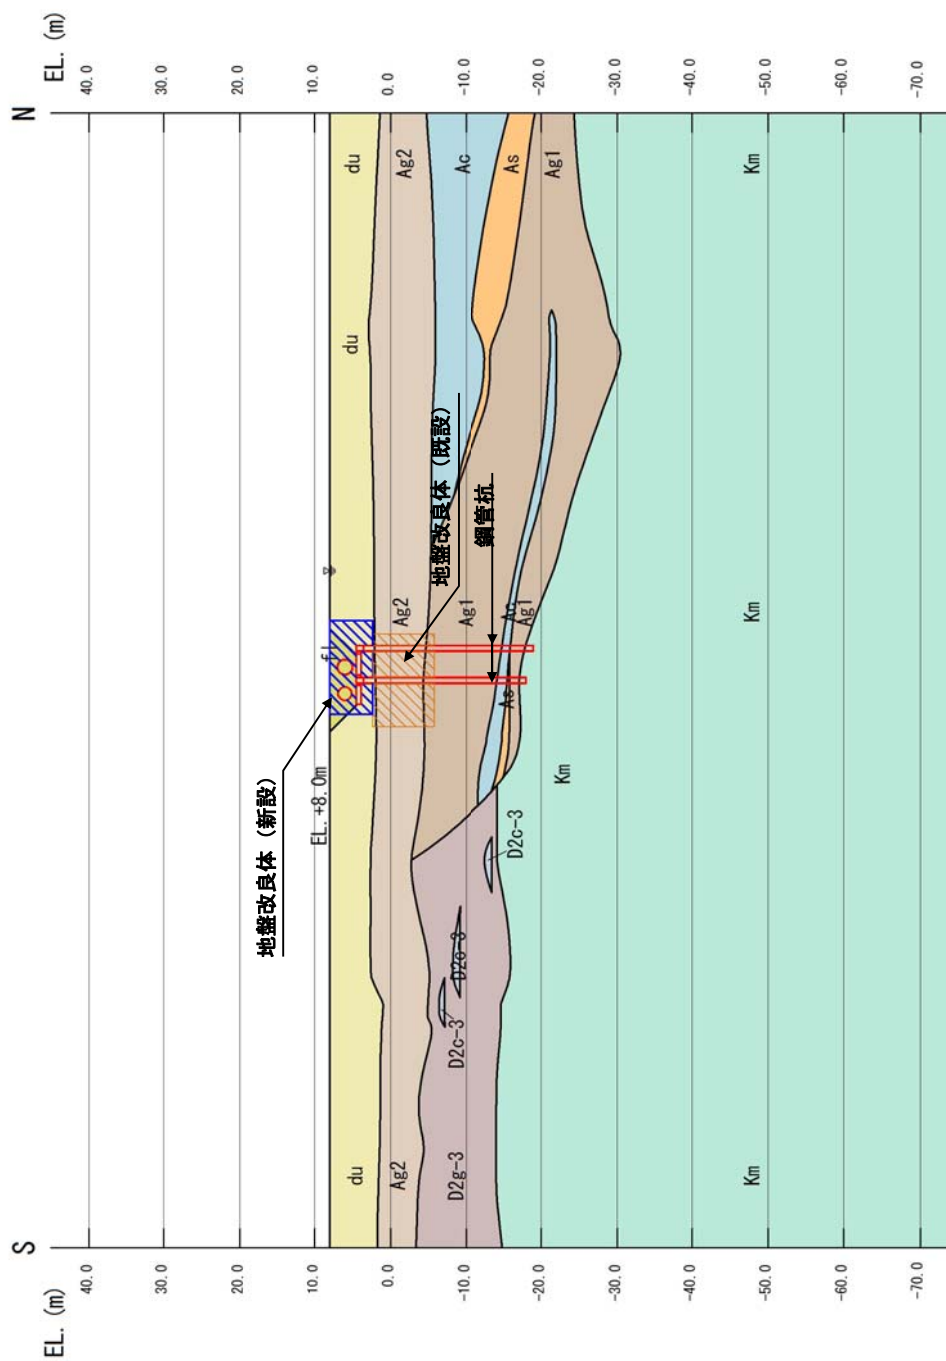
(3) 屋外二重管基礎の評価対象断面図 (C-C 断面・杭基礎構造部)
